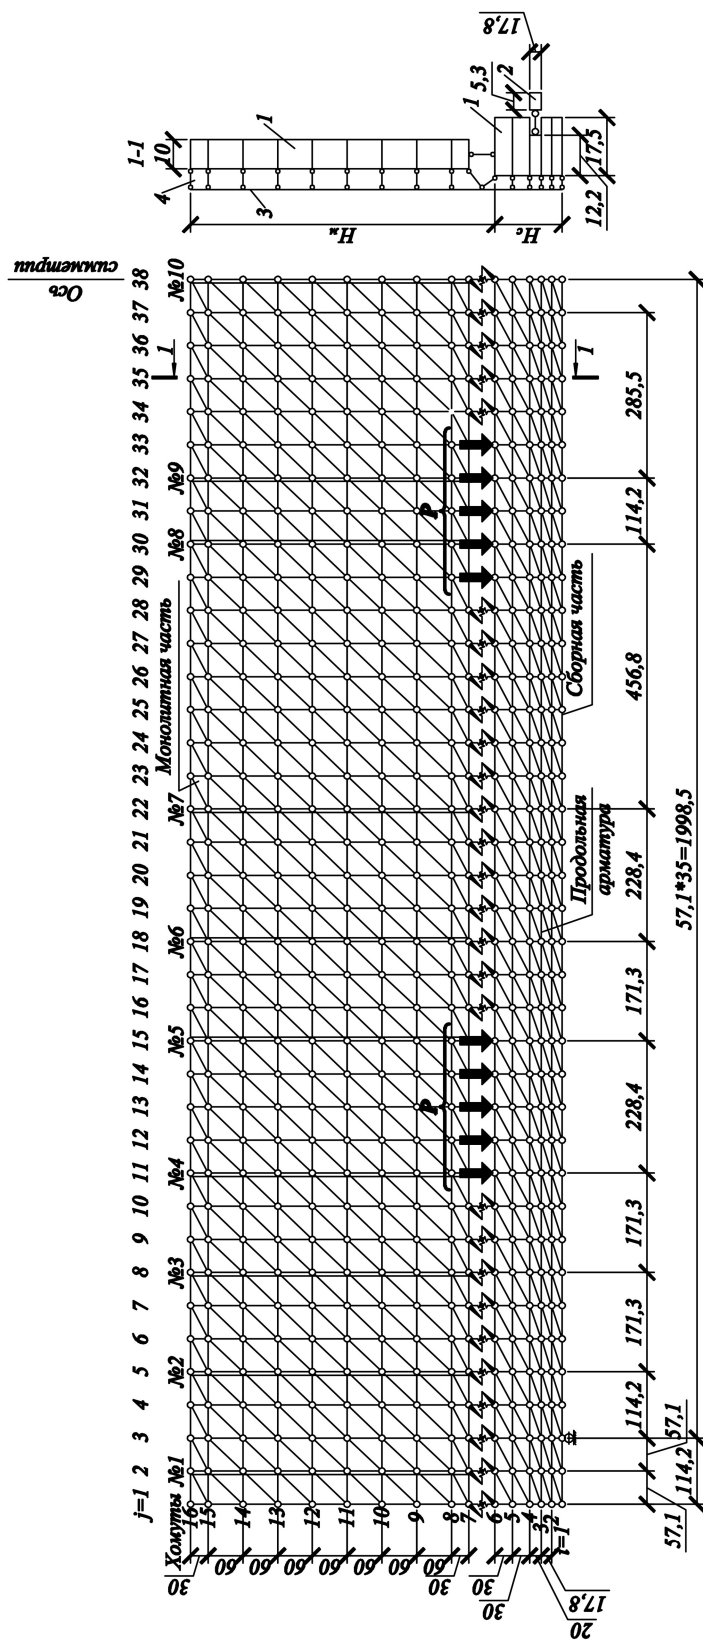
Расчетная схема сборно-монолитной железобетонной балки:
